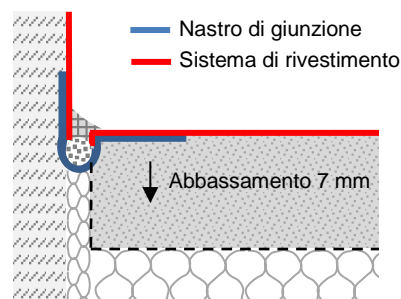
Giunto di transizione fra il massetto e la parete con nastro di giunzione ad anello e massa di sigillatura dei giunti.
